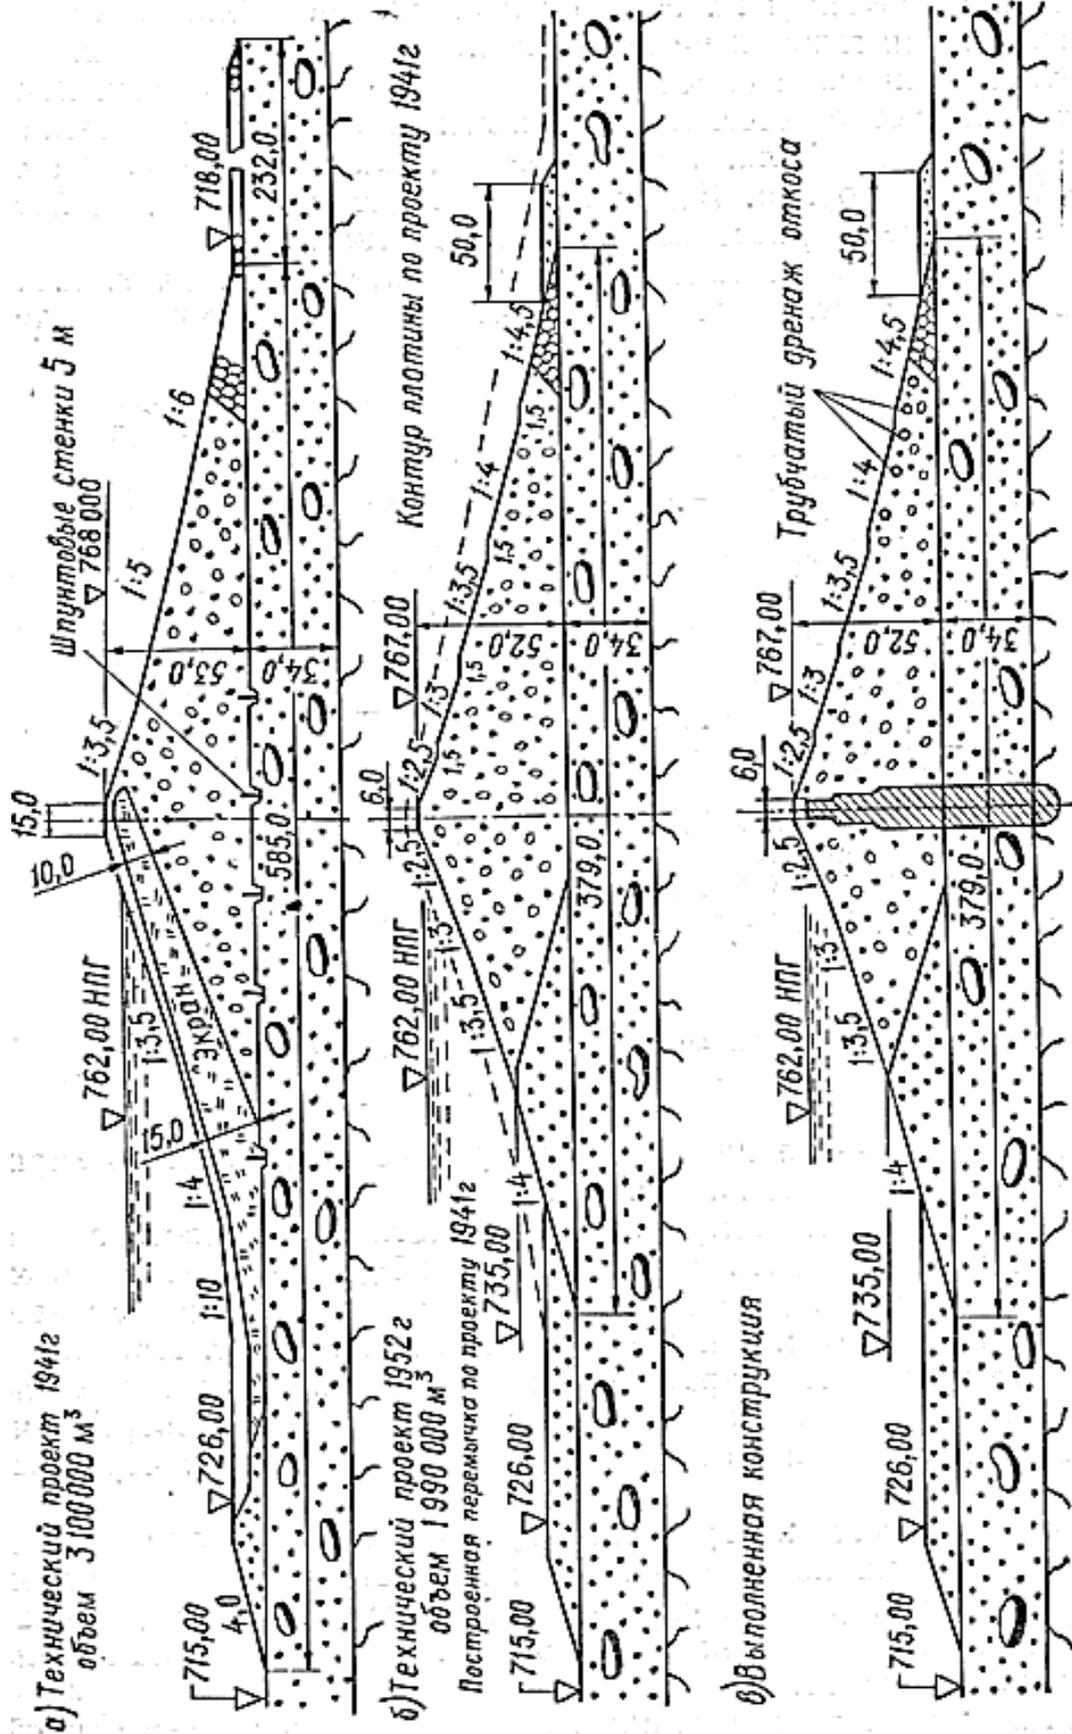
Поперечное сечение плотины по вариантам конструкции
